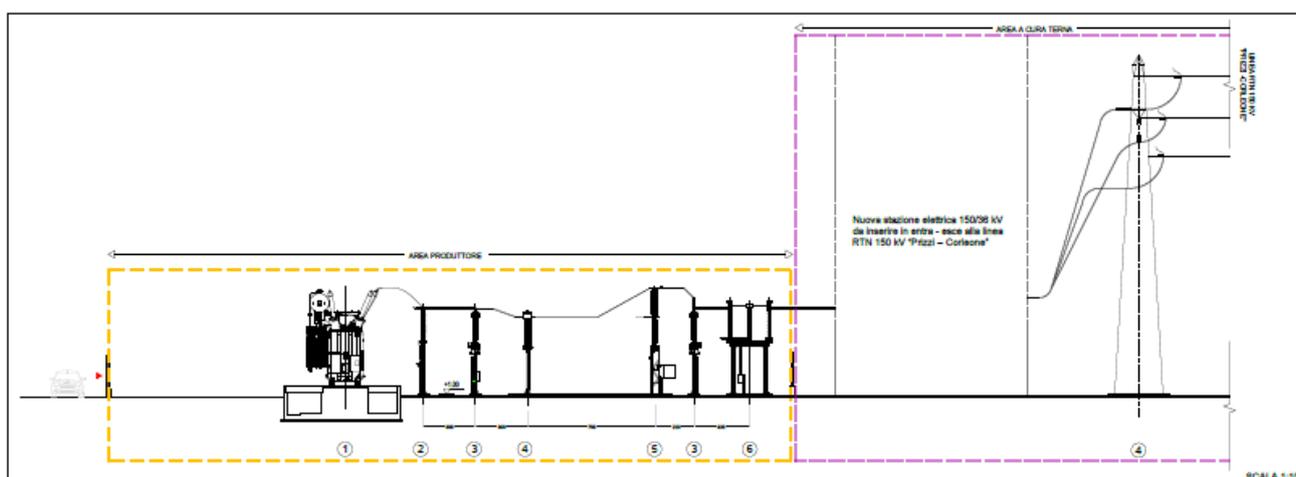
Sezione elettromeccanica che mostra il collegamento finale dell'impianto alla rete elettrica
